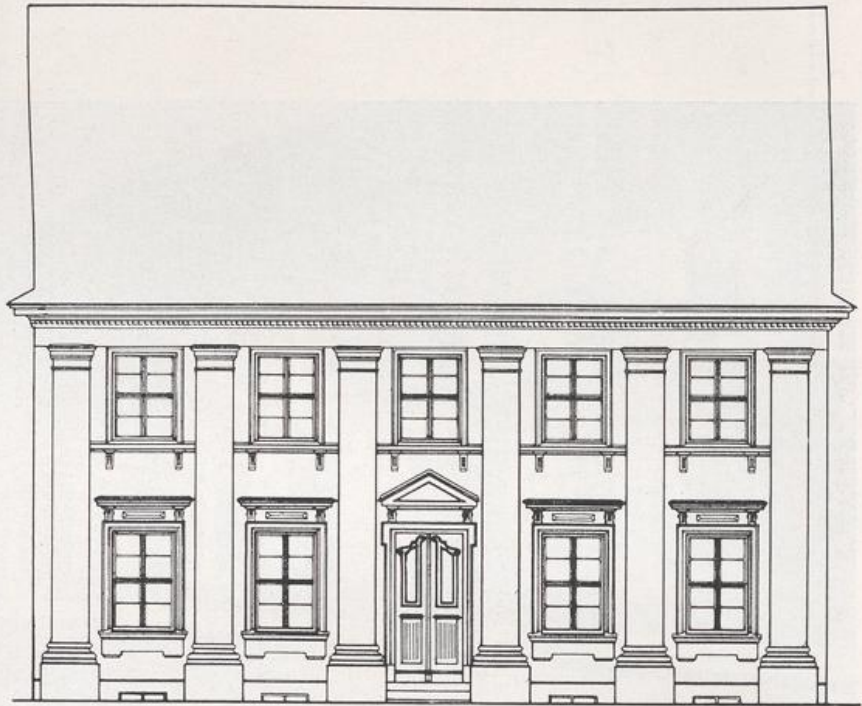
Haus Friedrichstraße 42 nach Brasch's Entwurf
